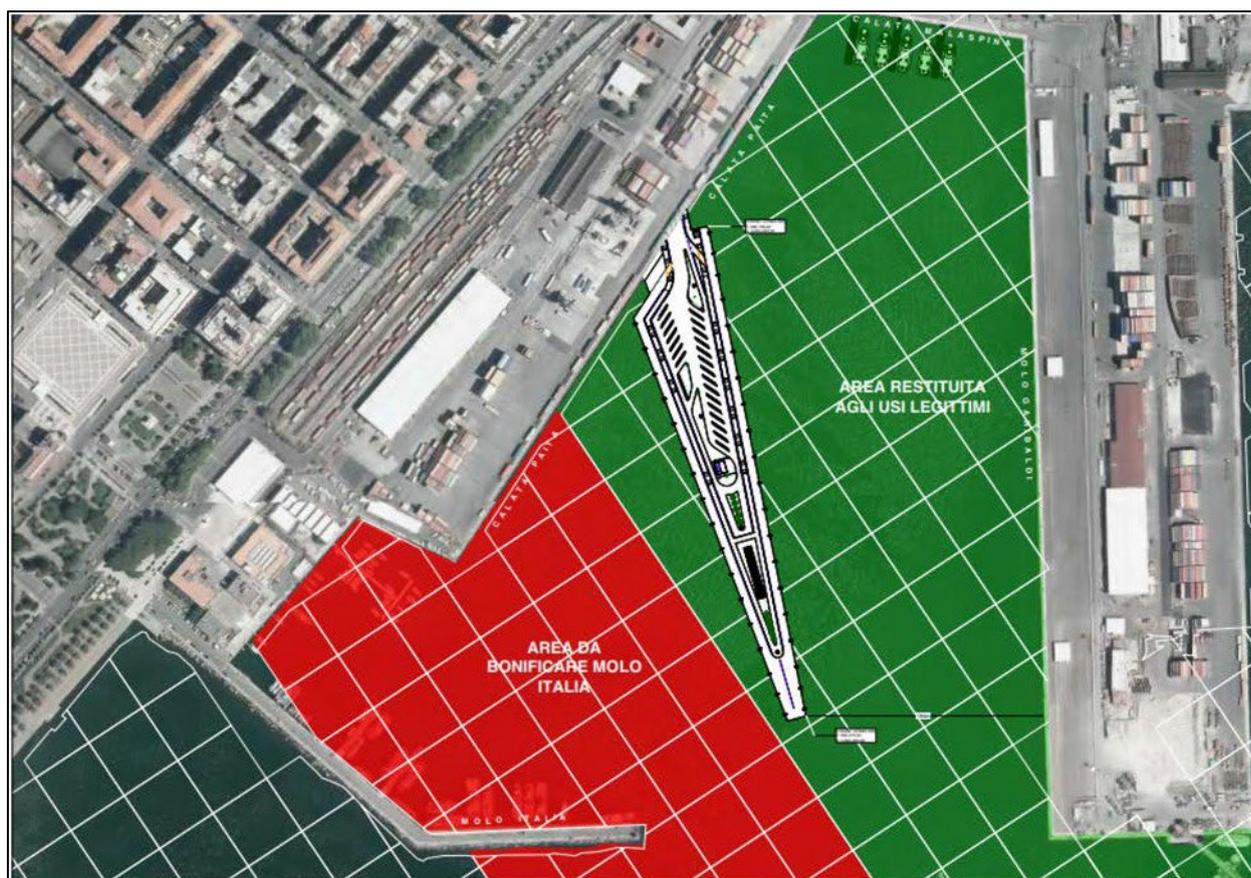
Estratto dalla tavola di Esecutivo Bet001\_0 "Posizionamento del progetto rispetto al SIR di Pitelli".
